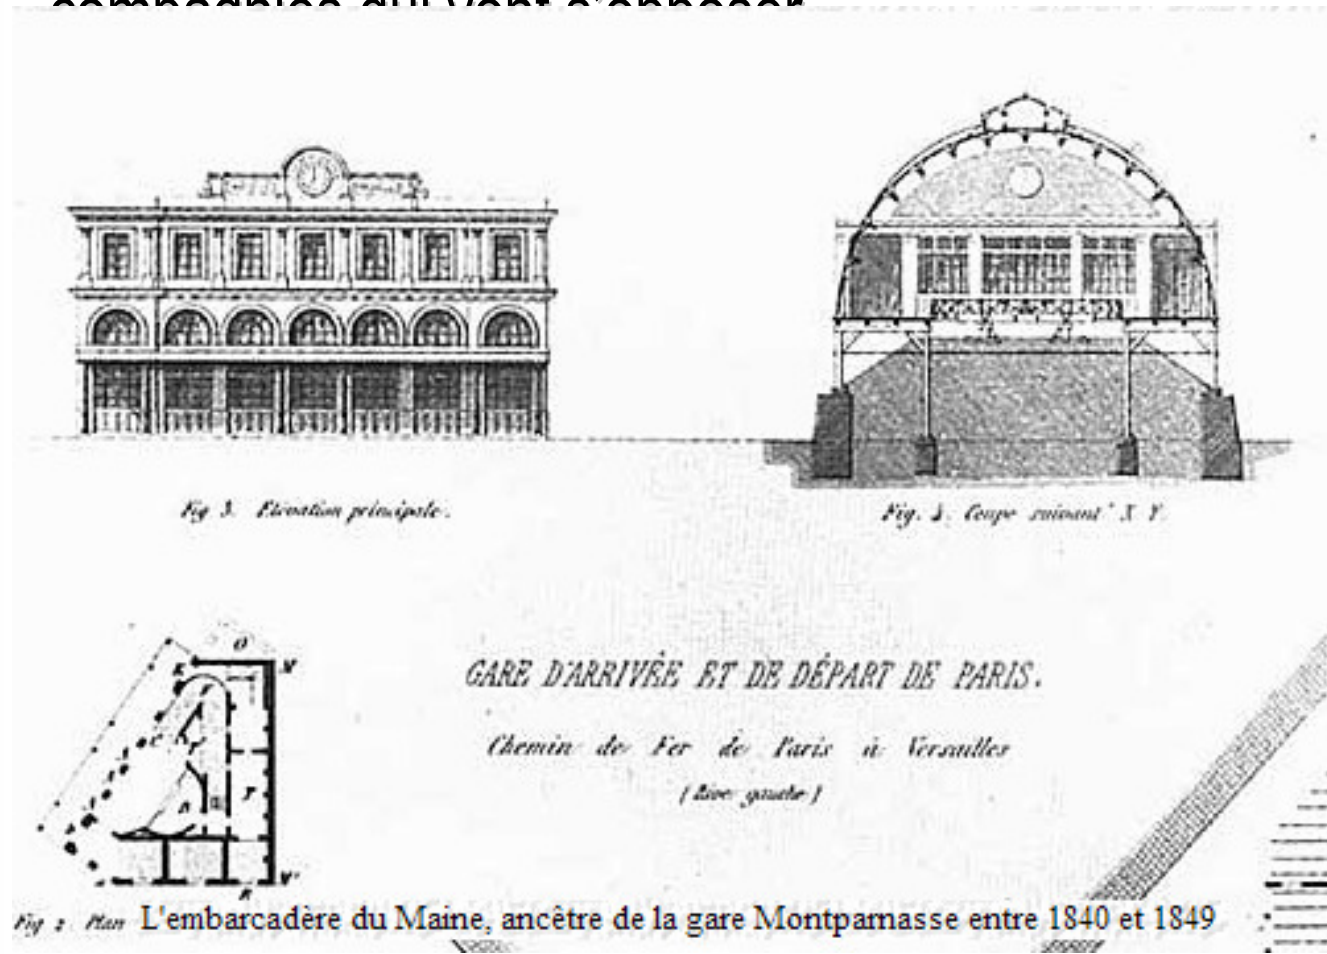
Plan L'embarcadère du Maine, ancêtre de la gare Montparnasse entre 1840 et 1849
